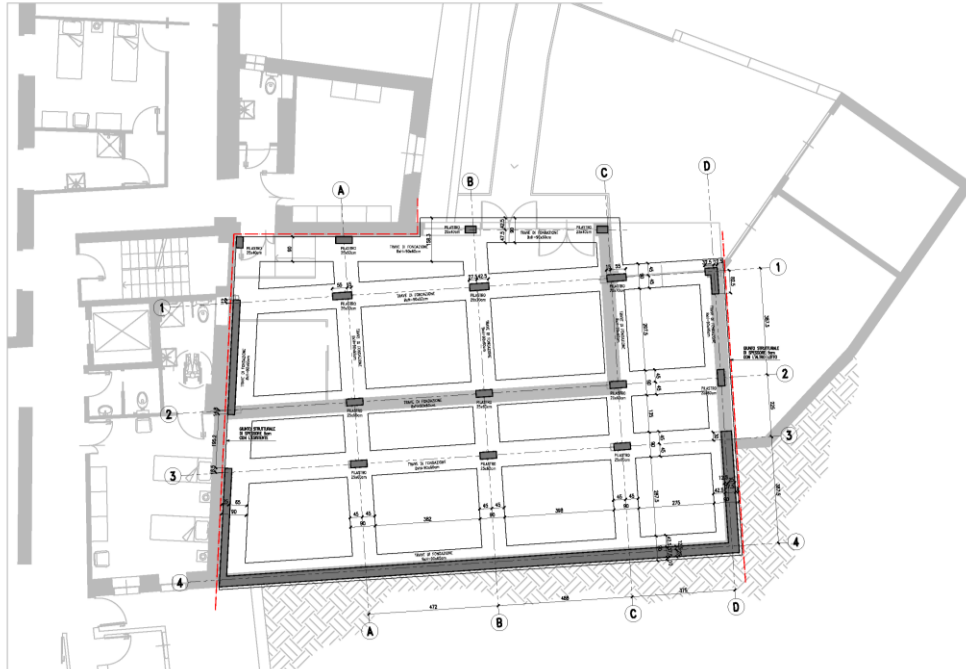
Carpenteria travi di fondazione in c.a. gettato in opera
